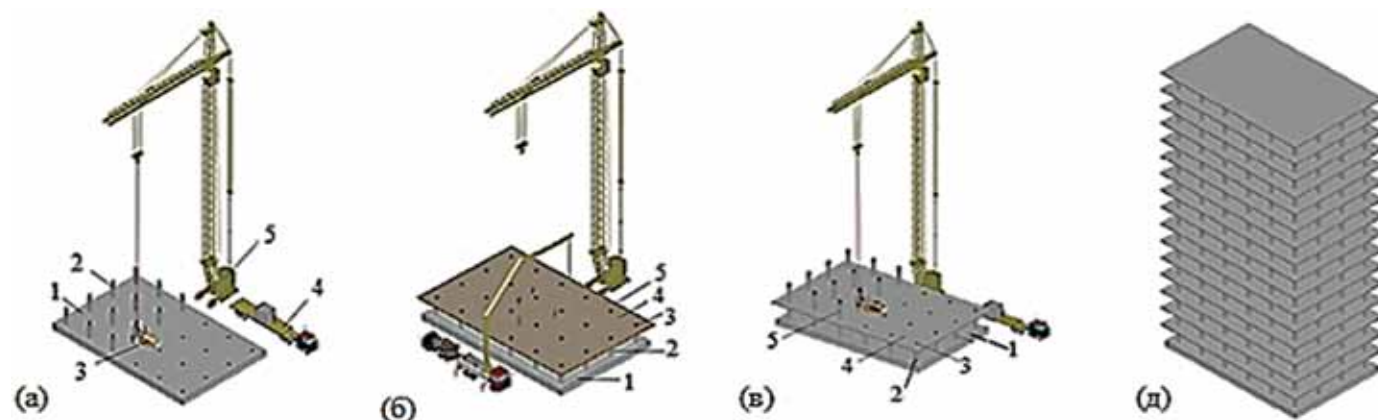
а) Монтаж колонн первого этажа: 1 – фундамент, 2 – колонны, 3 – специальная машина для монтажа колонн, 4 – грузовая платформа, 5 – башенный кран; б) Подготовка и заливка бетона первого этажа: 1 – фундамент, 2 – колонны, 3 – закладные детали верхней части колонн, 4 – армирование, 5 – деревянная опалубка для перекрытий, 6 – деревянная опалубка для ригеля; в) Монтаж колонн второго этажа: 1 – фундамент, 2 – колонны, 3 – закладные детали верхней части колонн, 4 – монолитная плита первого этажа, 5 – ригели первого этажа, 6 – колонны второго этажа; г) Завершенное здание
